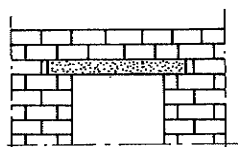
Béton coulé contre un placage en terre cuite (ou en béton).
